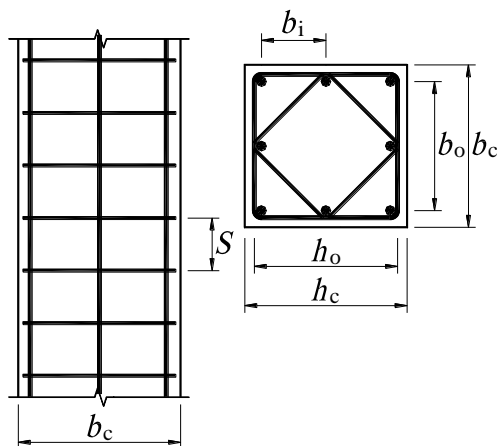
Ограничивающее (поперечное армирование) ядра колонны
